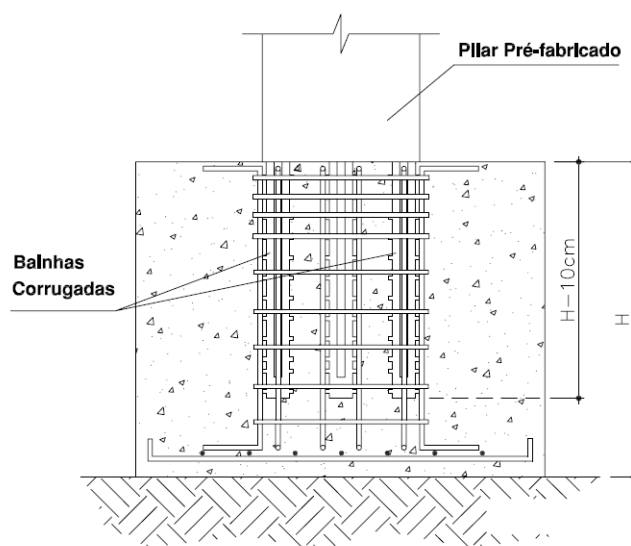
Ligação pilar-fundação com armaduras salientes do pilar (adaptado de [1])
